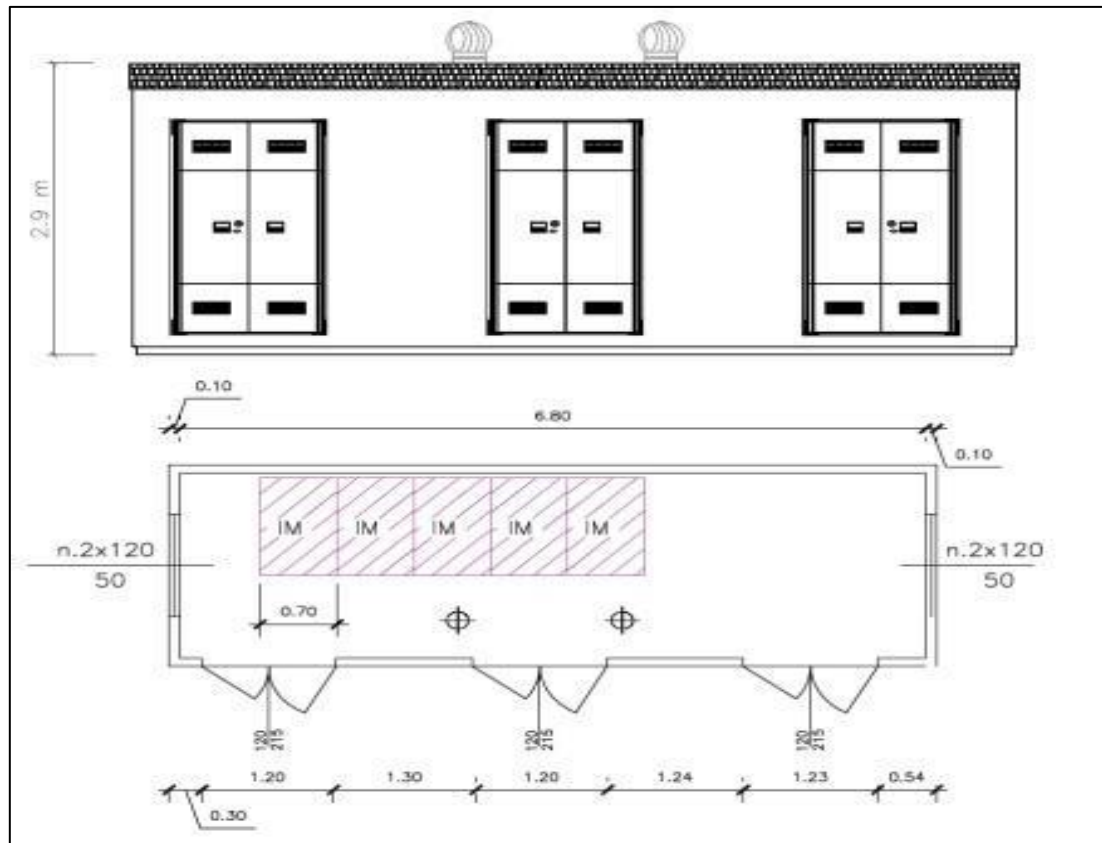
Prospetti e planimetria della cabina di sezionamento – Elaborato grafico di riferimento SLC 060
